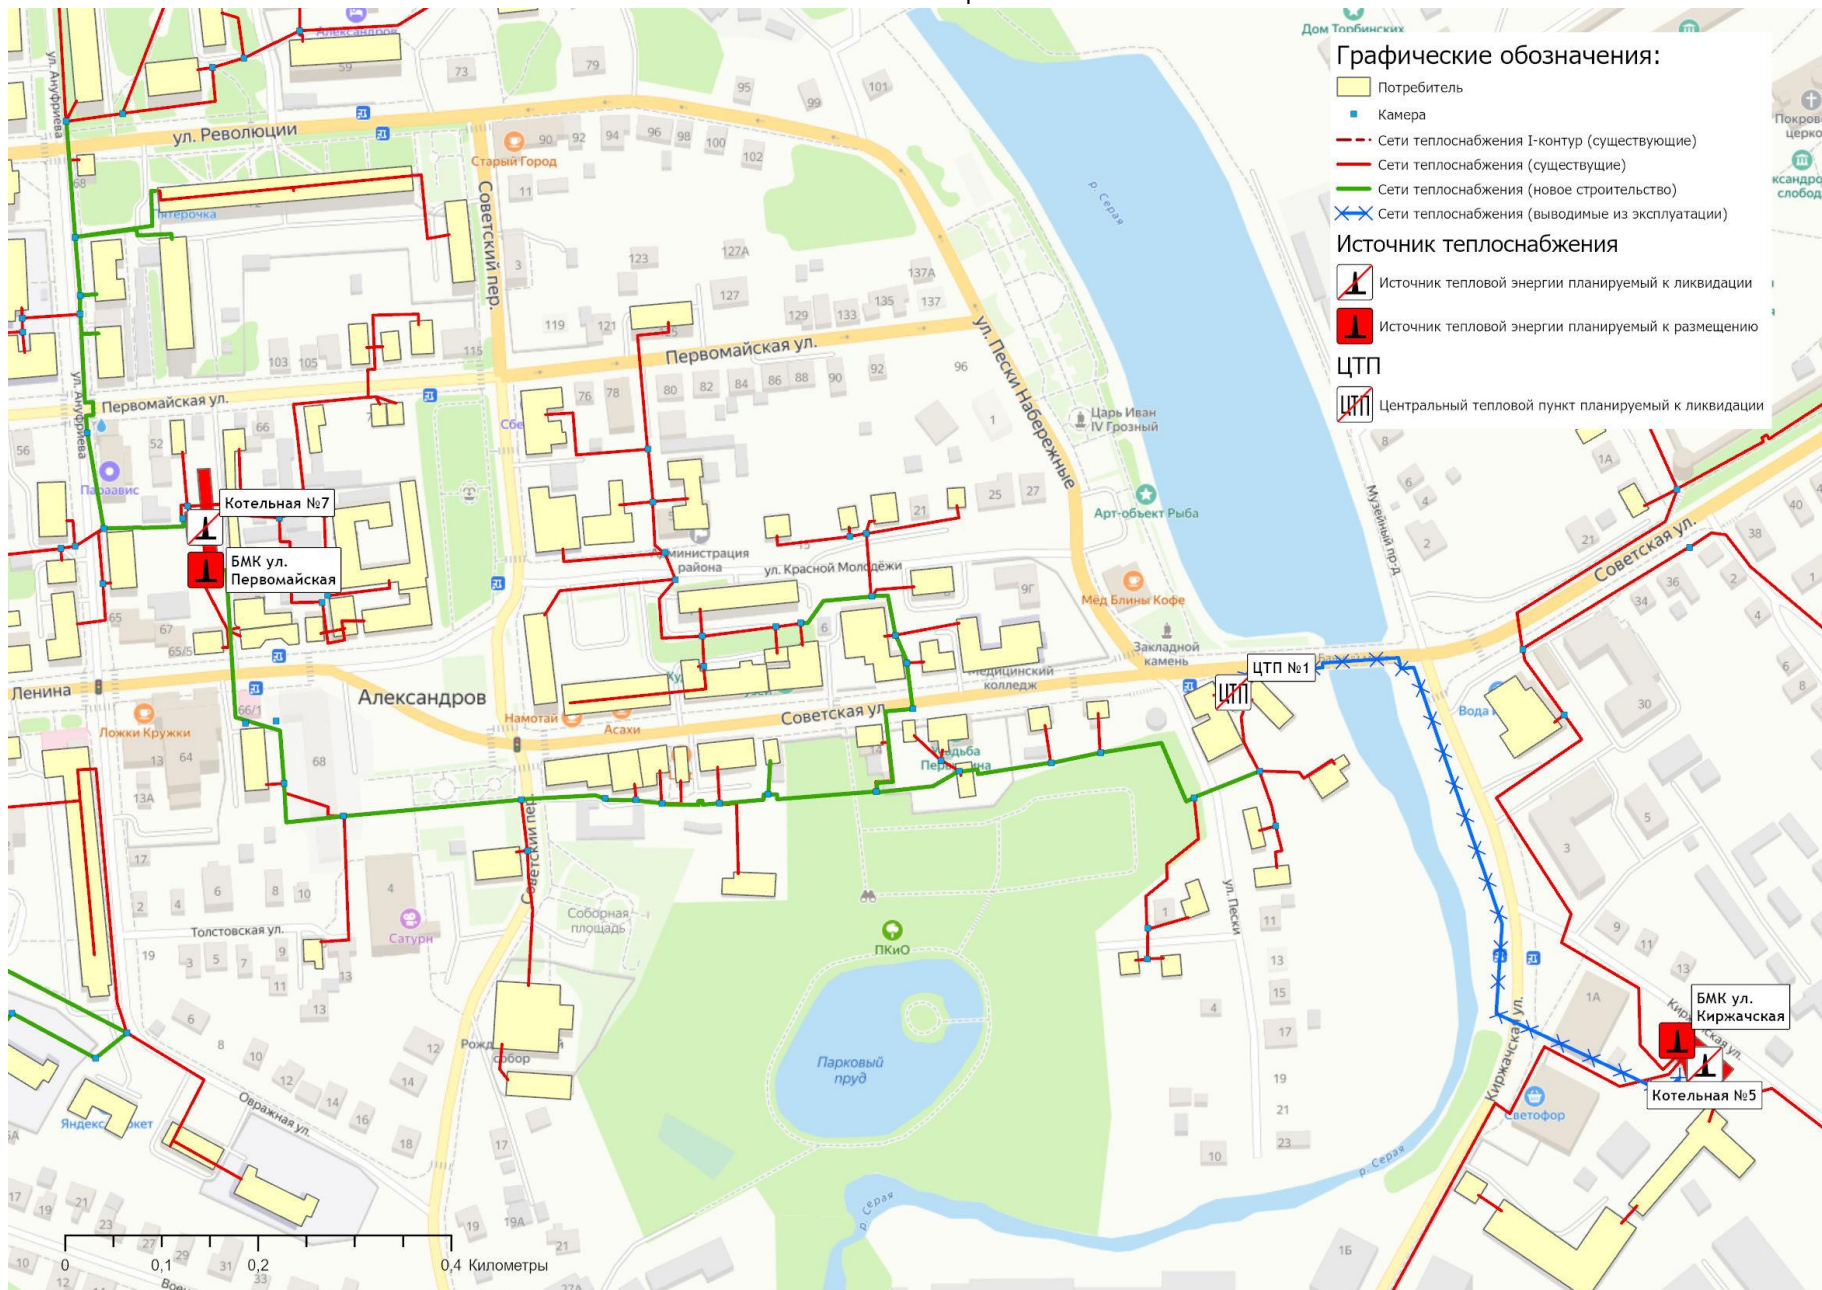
Переключение тепловой нагрузки с ЦТП №1 на котельную по ул. Первомайская
